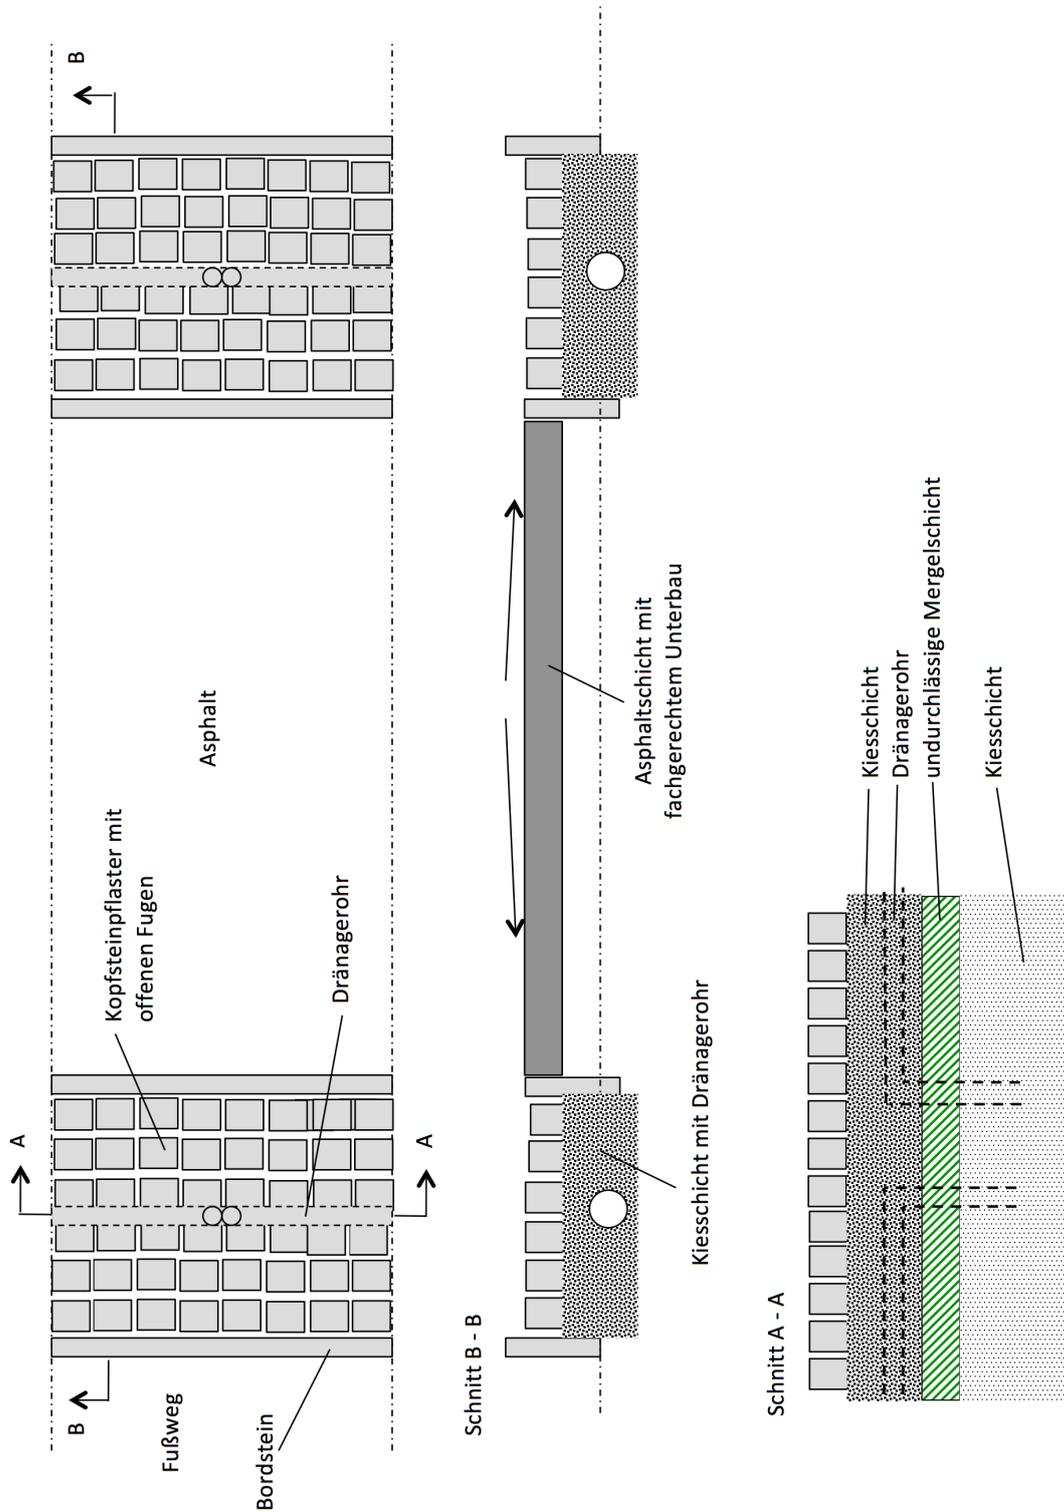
neuer Straßenaufbau für eine dreispurige Straße
